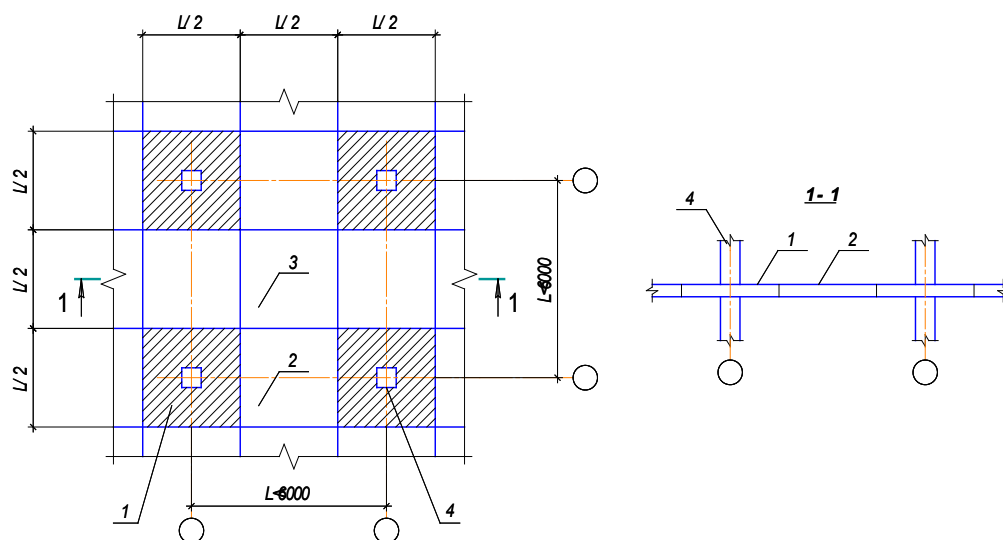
Плоское сборно-монолитное перекрытие пролетом 6 м
